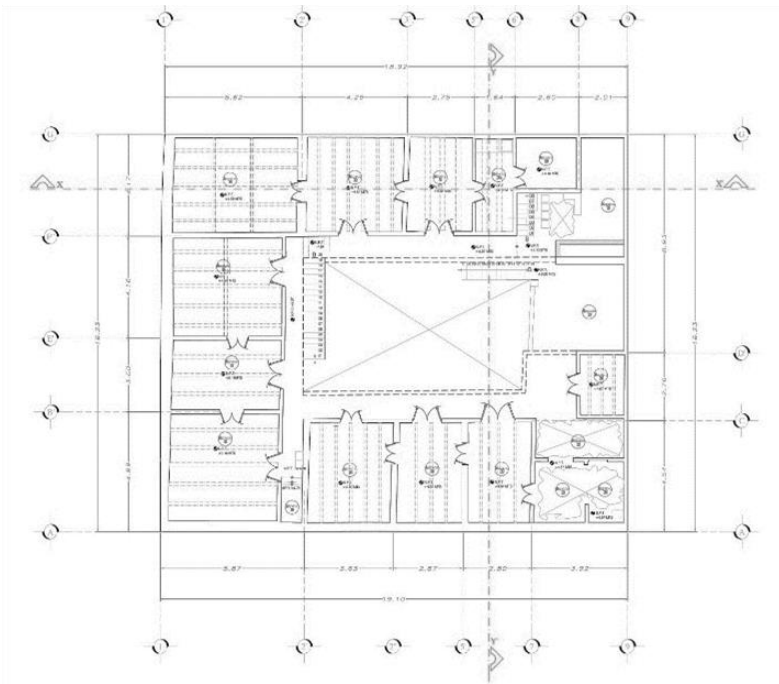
Plano de distribución de vigas. Planta alta. Fuente propia: Arq. Jacqueline Sánchez con fecha Enero 2016
